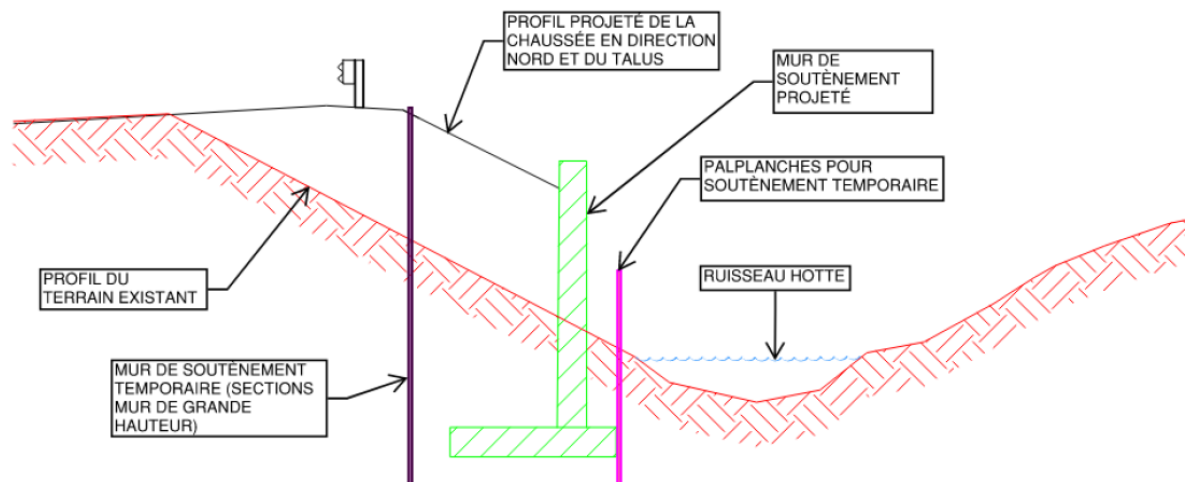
Coupe du mur projeté et des ouvrages temporaires requis
